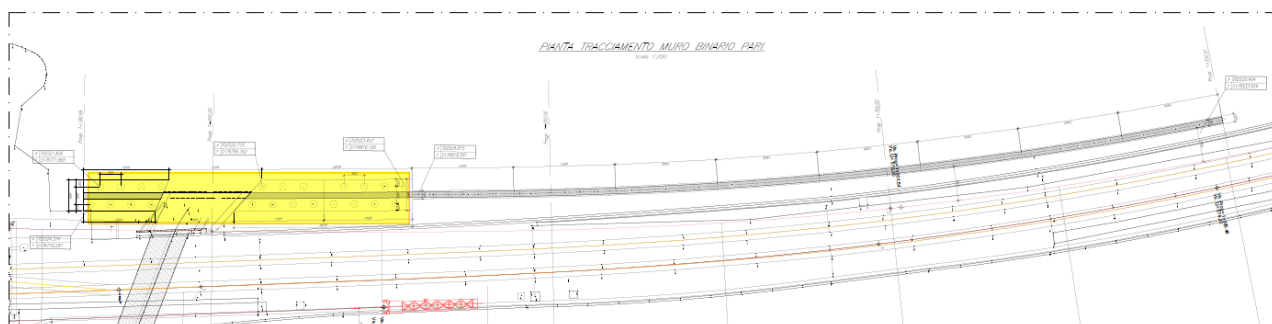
Individuazione Muro di scavalco in c.a. su fondazioni profonde – Planimetria
